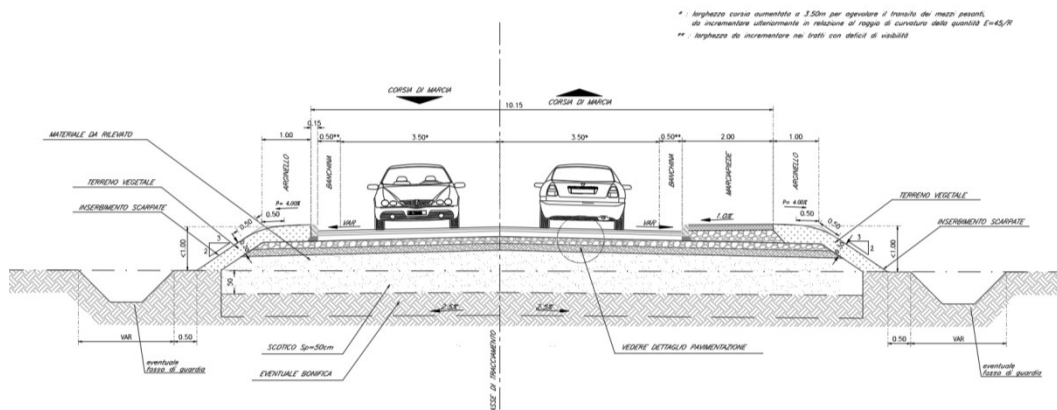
Sezione tipo in rilevato della viabilità NV02
